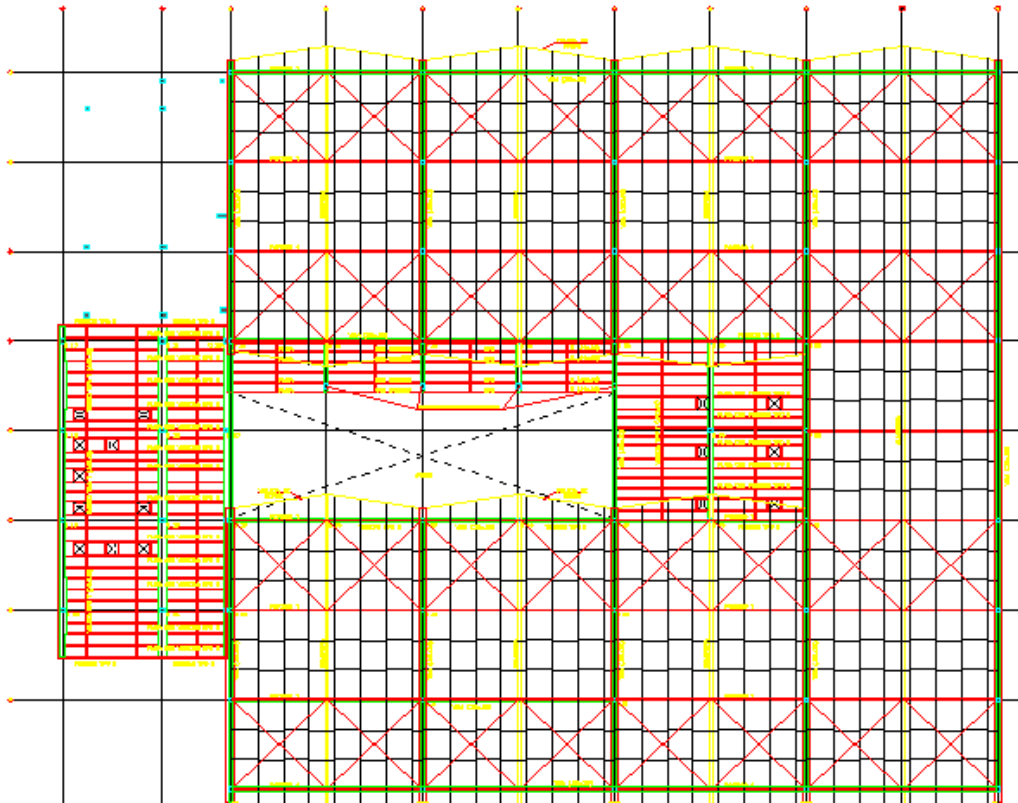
Planta Estructural cubierta Estructura 2.1
